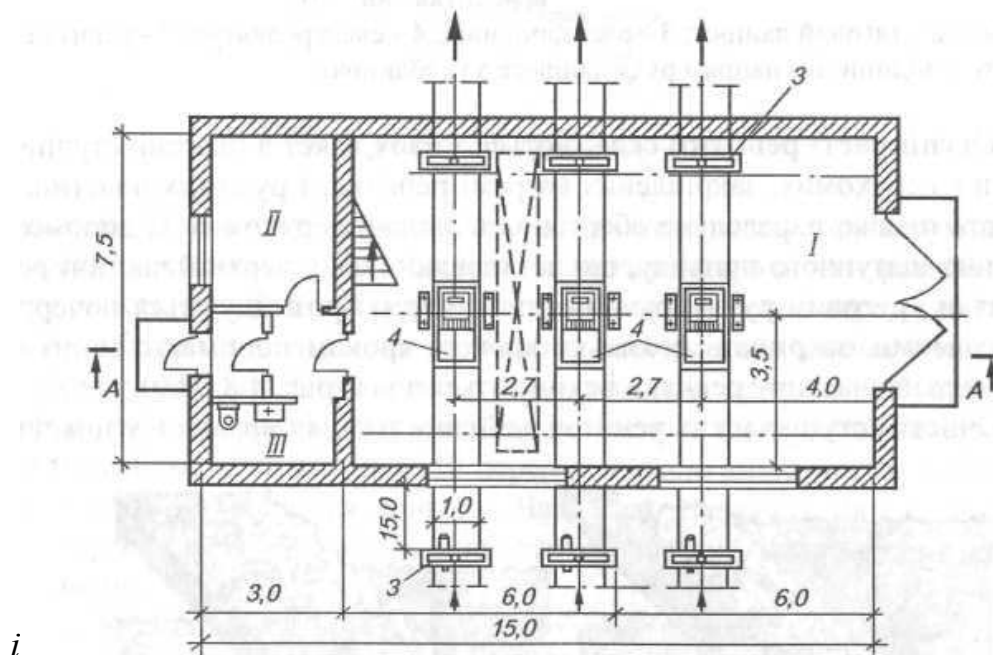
Будівля з трьома ґратами типу РМУ-3 (варіант з вивезенням покидьків):
